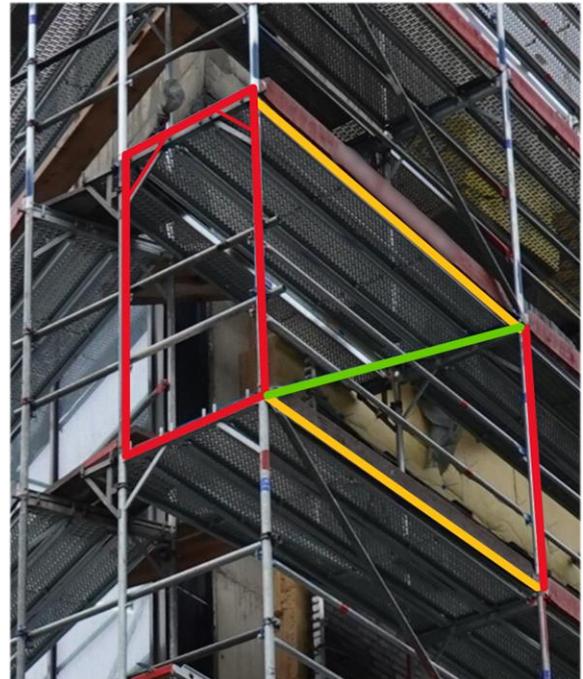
Gerüst an einer Hauswand (Bild: Bundesinnung Gerüstbau)
